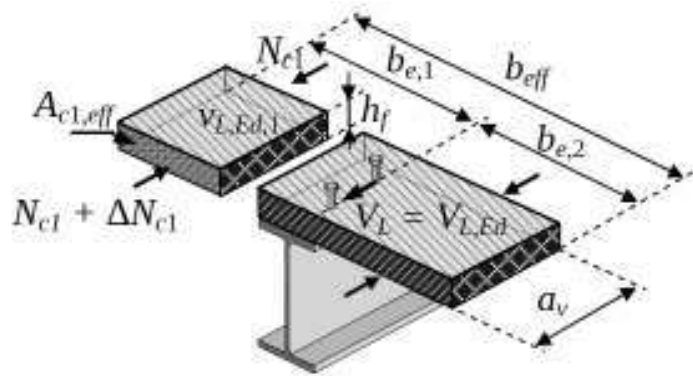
К уточненному выражению для определения касательных напряжений от продольного сдвига в сталежелезобетонных балках
